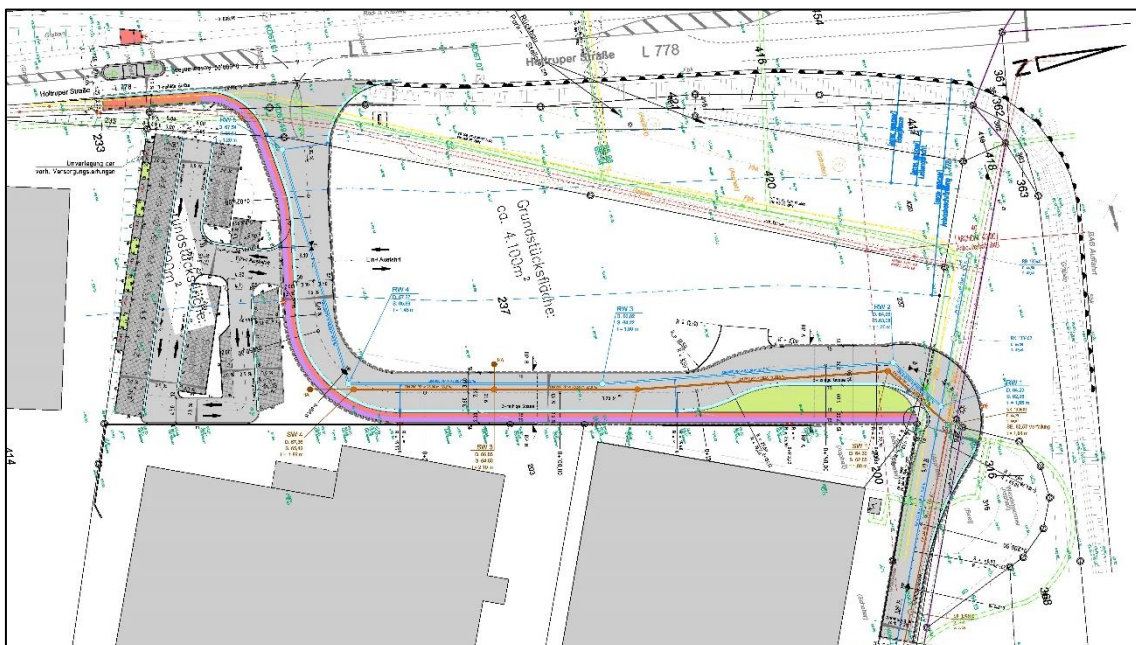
Erschließungsplanung, Stand 25.10.2021 (Quelle: iNplan GmbH)
